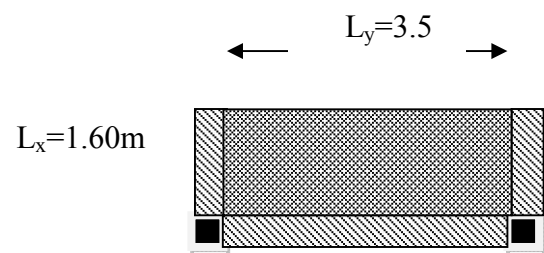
schéma de la dalle pleine sur trois appuis D_1
